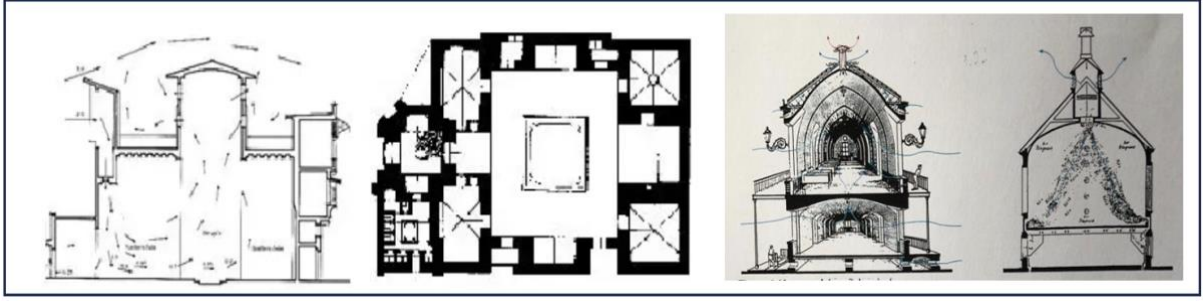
Villa Rotonda'nın Merkezindeki Havalandırma Boşluğunun Plan Ve Kesitte Görünümü, (Url-6).
